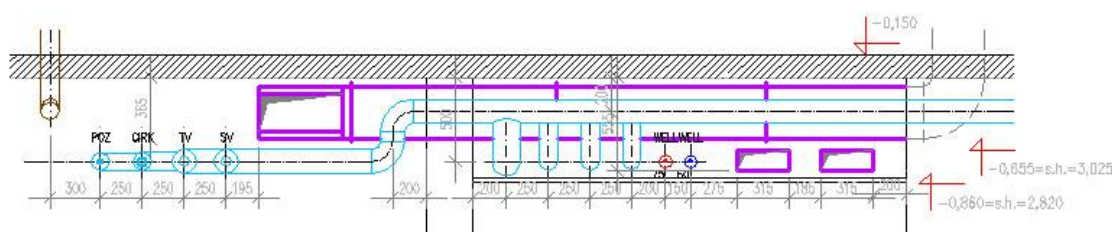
Příklad koordinačního výkresu části půdorysu
